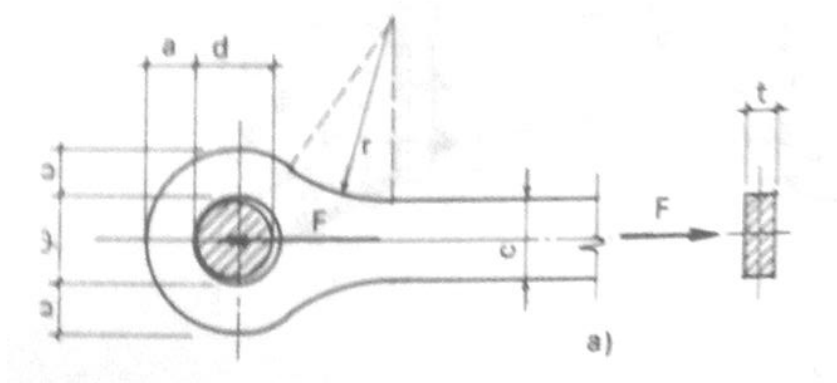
Perno di collegamento soppalco-trave reticolare
